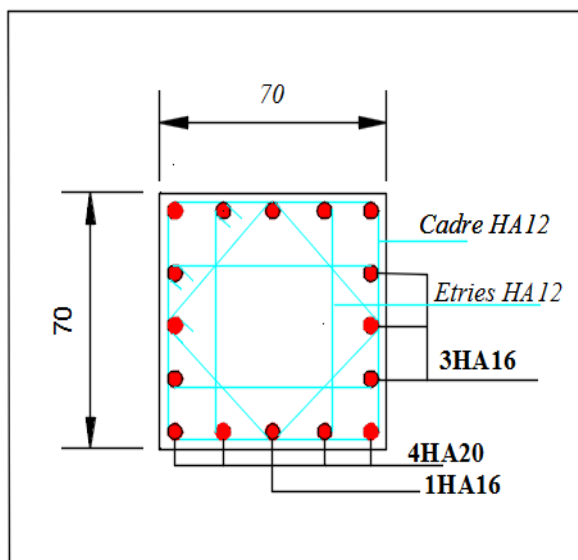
schéma de ferrailage des poteaux RDC, sous sol
